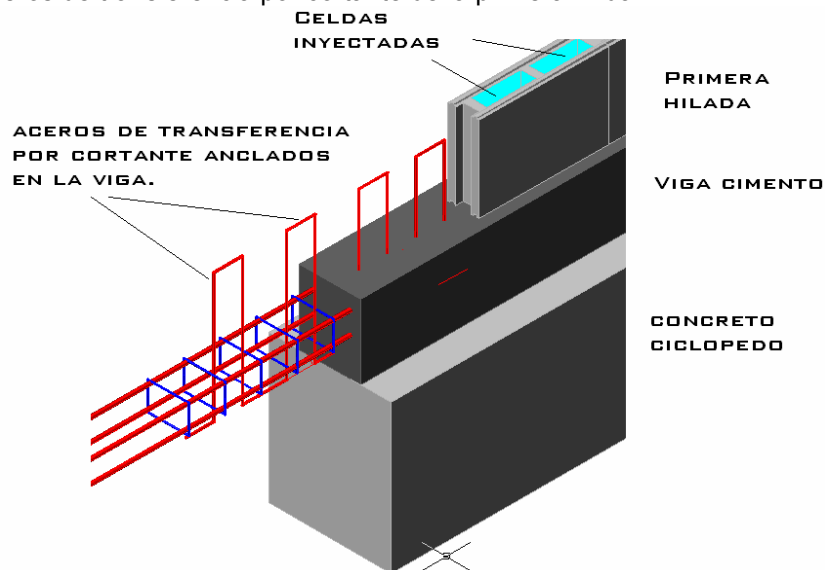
DETALLE VIGA CIMENTO, ACEROS DE TRANSFERENCIA ANCLADOS EN LA VIGA.
